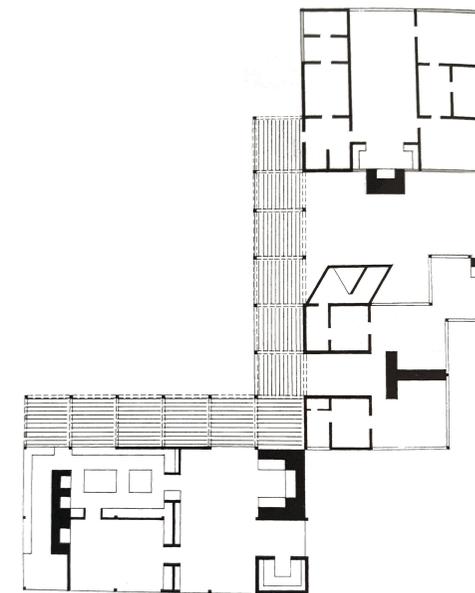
Planta Casa Honickman. Louis I.Kahn. 1971-1974; no construida. Filadelfia, Pensilvania.
